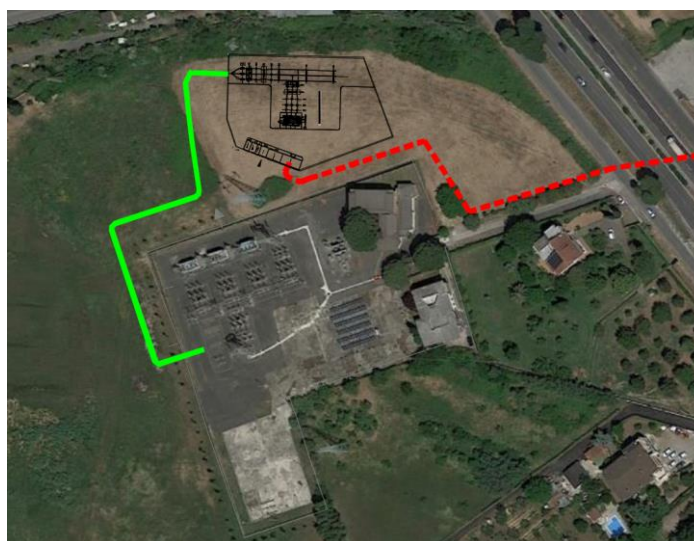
INQUADRAMENTO DELL'AREA STEP-UP CON IL COLLEGAMENTO IN MT (IN ROSSO) E IL COLLEGAMENTO IN AT DALL'AREA DI STEP-UP ALLA CABINA DI E-DISTRIBUZIONE (IN VERDE)
